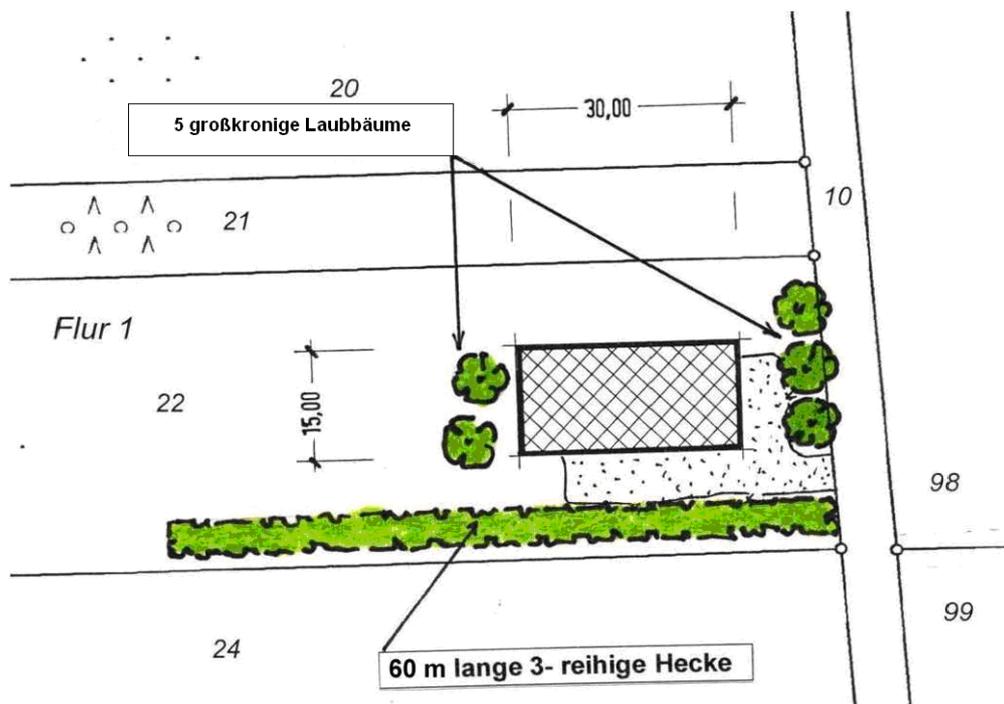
Lageplan des Bauvorhabens (mit Vermessung)
